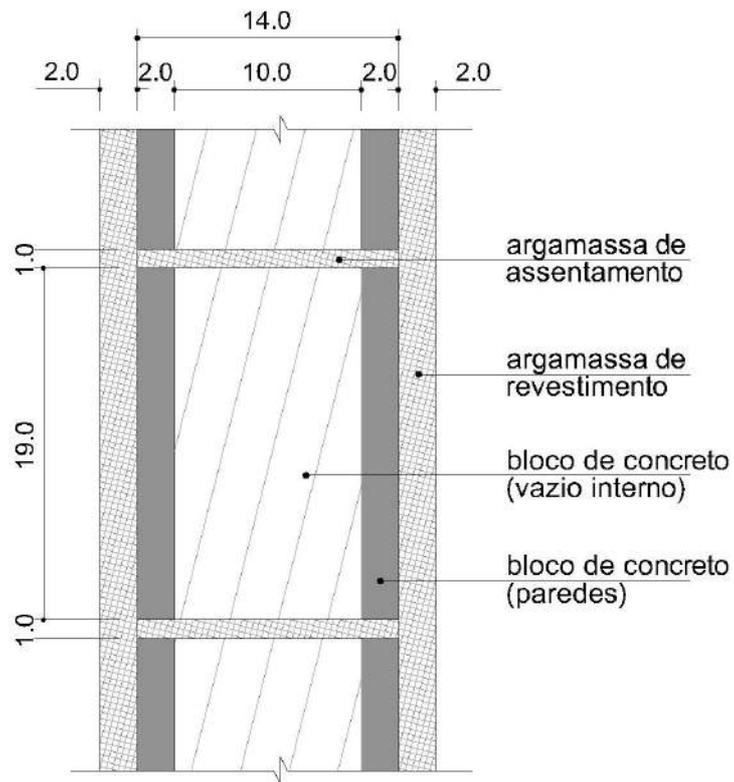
Detalhamento Construtivo da Alvenaria de Blocos de Concreto: Corte Vertical
